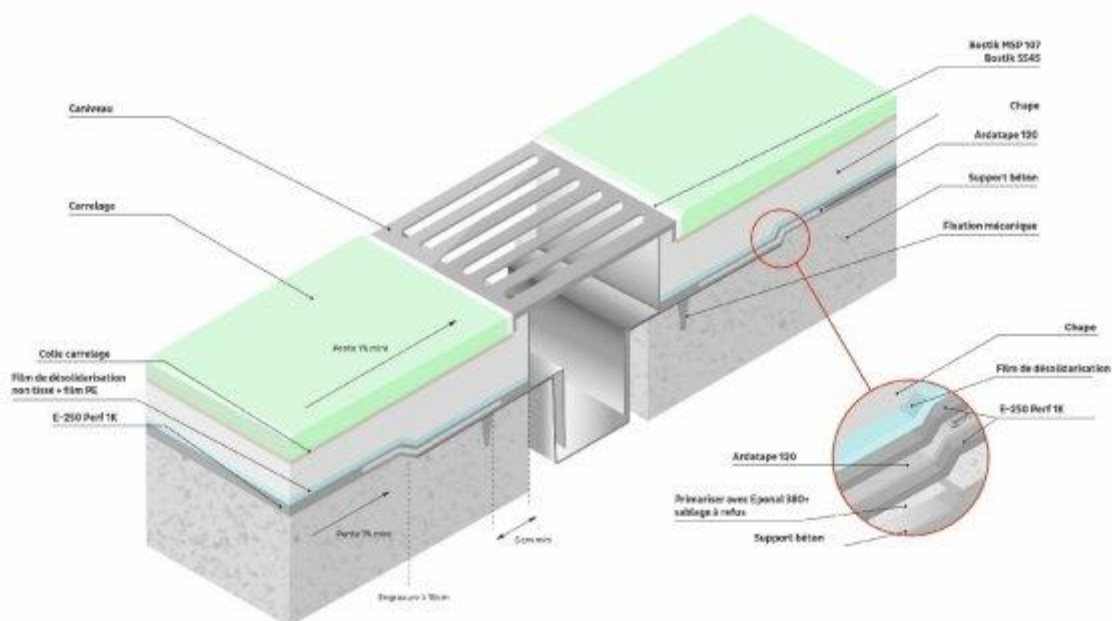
Raccordement à un caniveau – Cas d'une pose collée de carrelage sur chape sur E-250 PERF 1K
